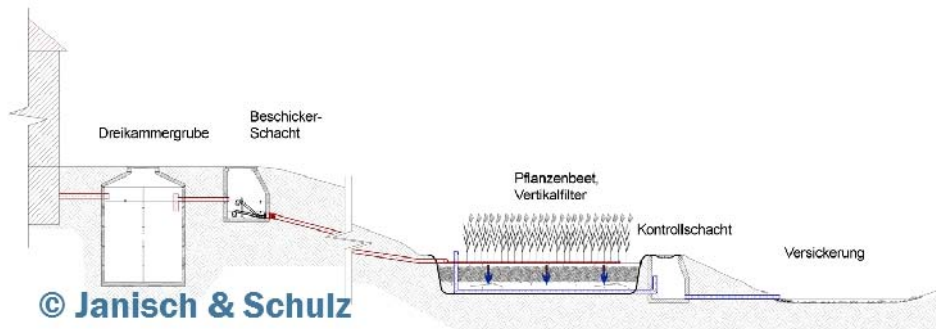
Funktionsschema einer vertikalen Pflanzenkläranlage der Firma Janisch & Schulz³
